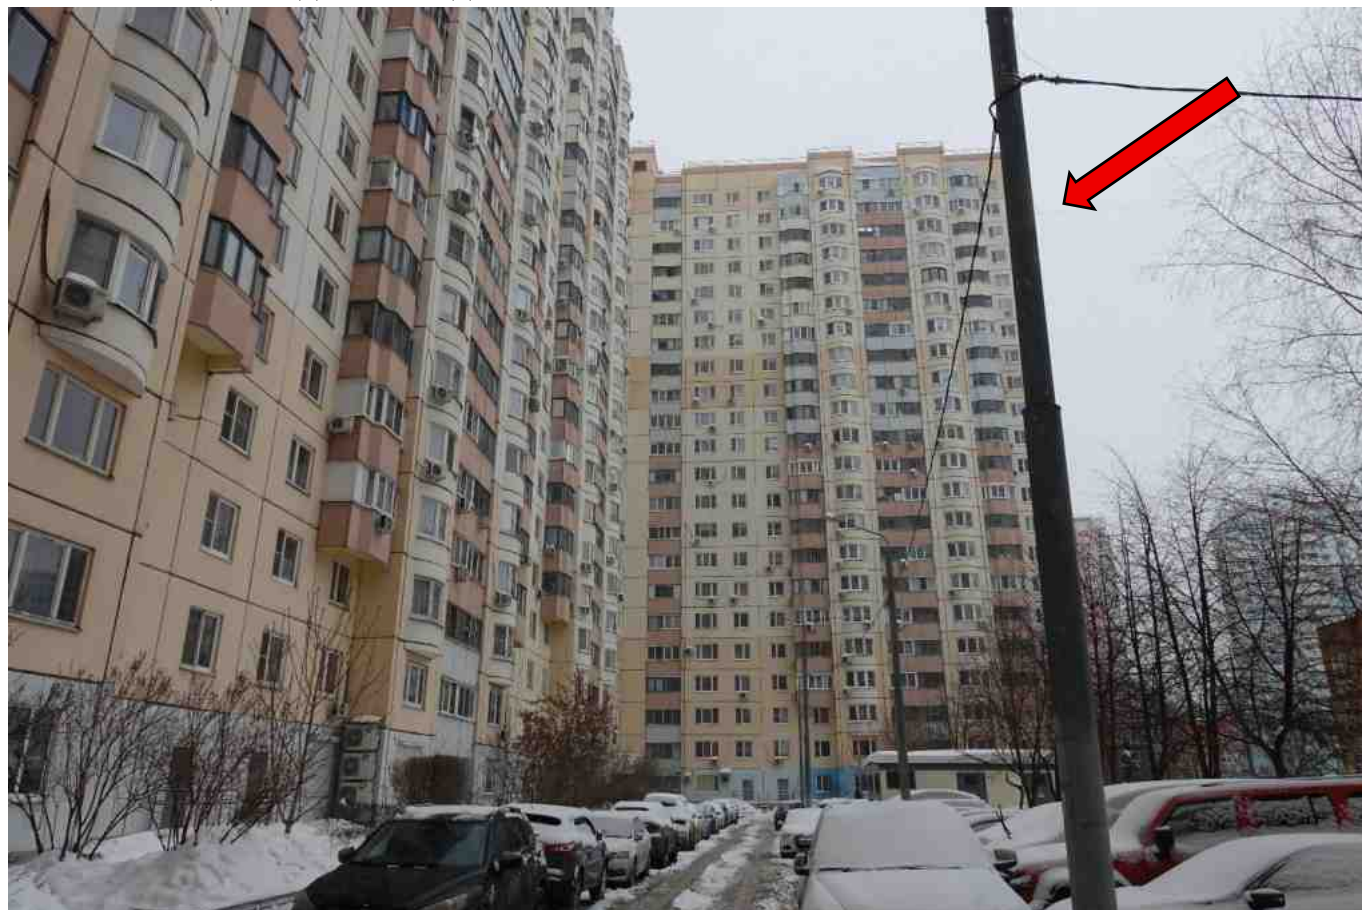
Общий вид жилого дома в/о 8/Ж-Г
